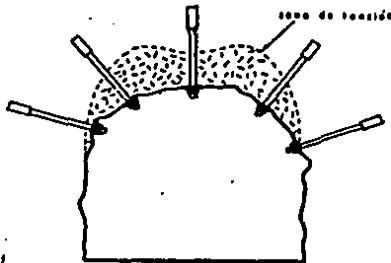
Refuerzo de una excavación arqueada que requiere soporte.
